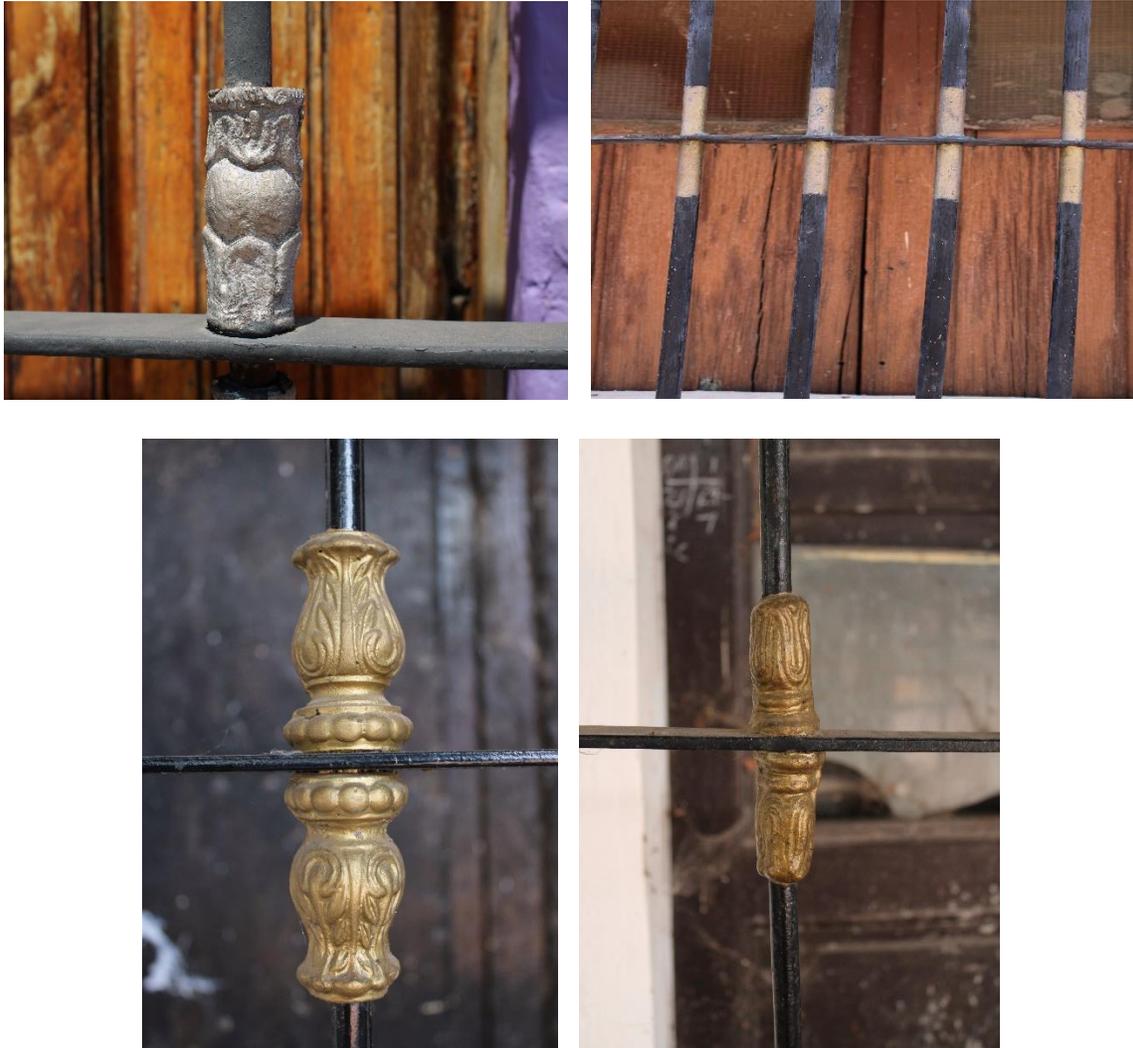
Diversas tipologías elementos decorativos de herrería para balcones
